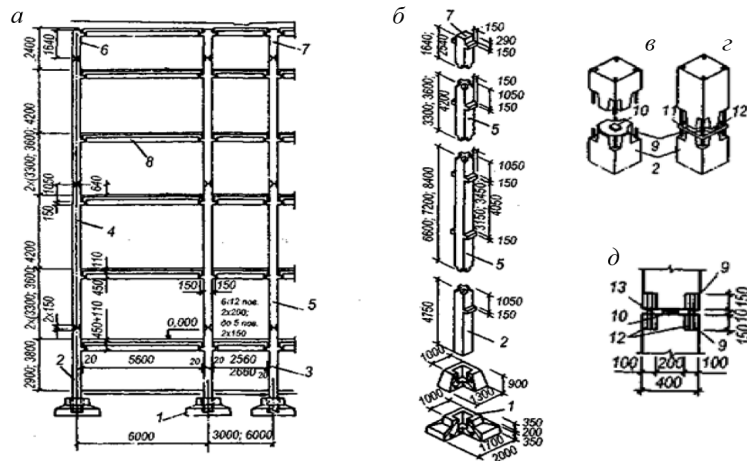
Монтажний план і розріз елементів каркаса:
